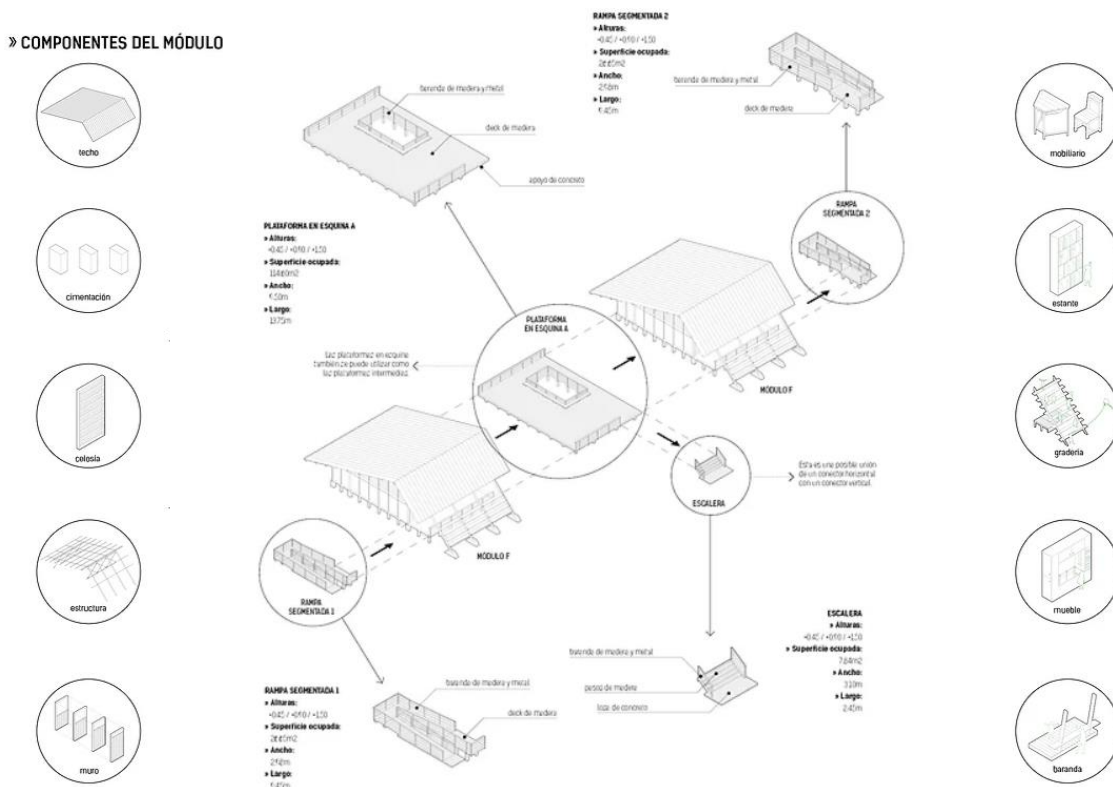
Ensamblajes módulos prefabricados -Plan Selva Infraestructura Escuela N°601453
